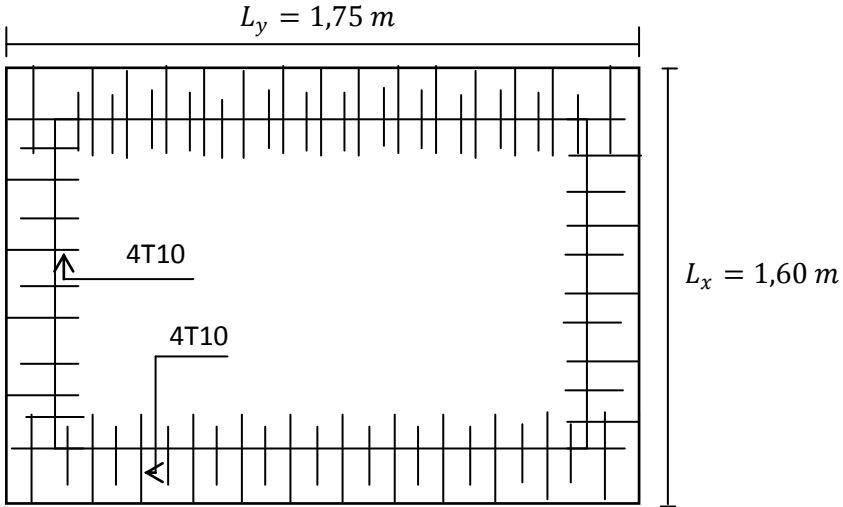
Ferrailage supérieur de la dalle de l’ascenseur.
